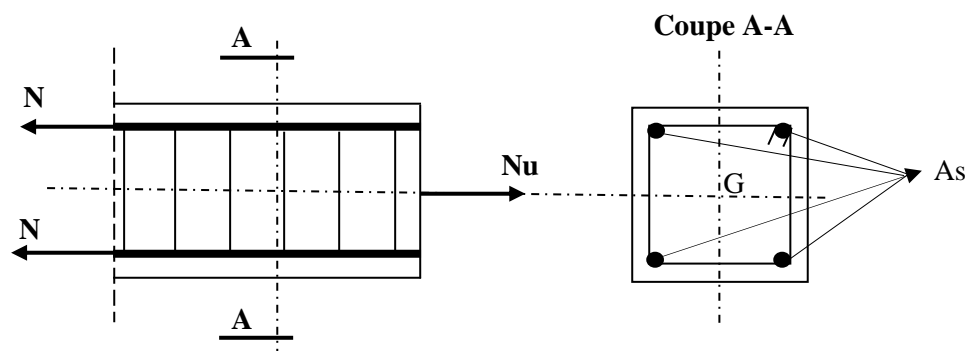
Disposition du ferrailage d'un tirant rectangulaire
